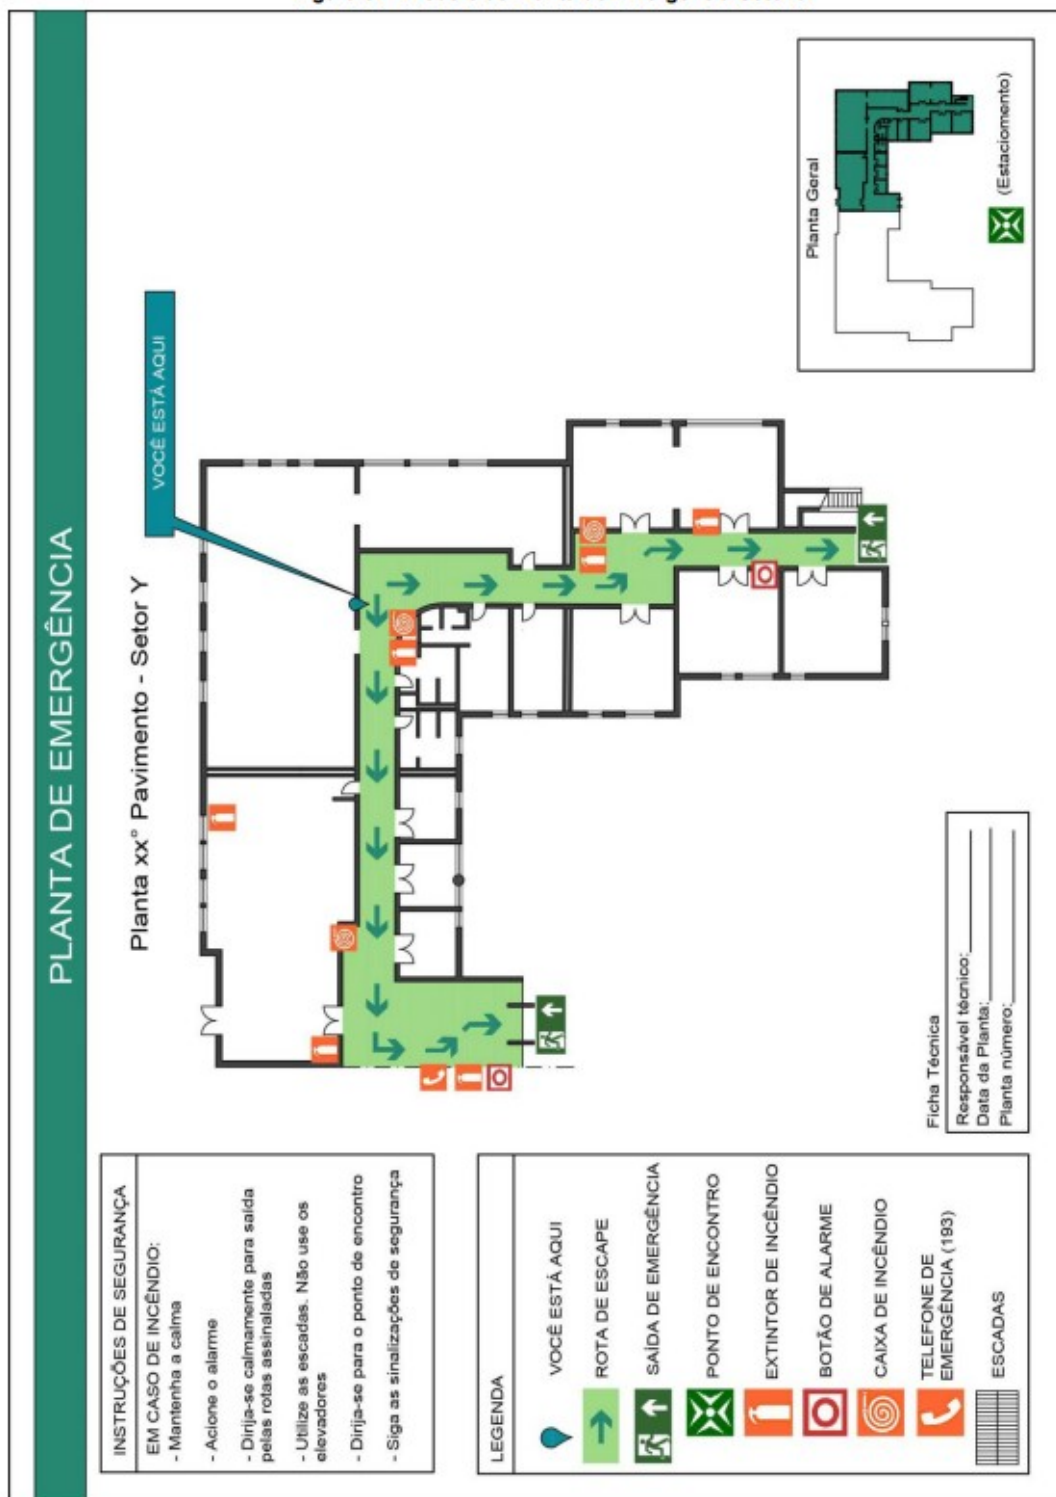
Exemplo de planta de emergência para pavimento de edificações
